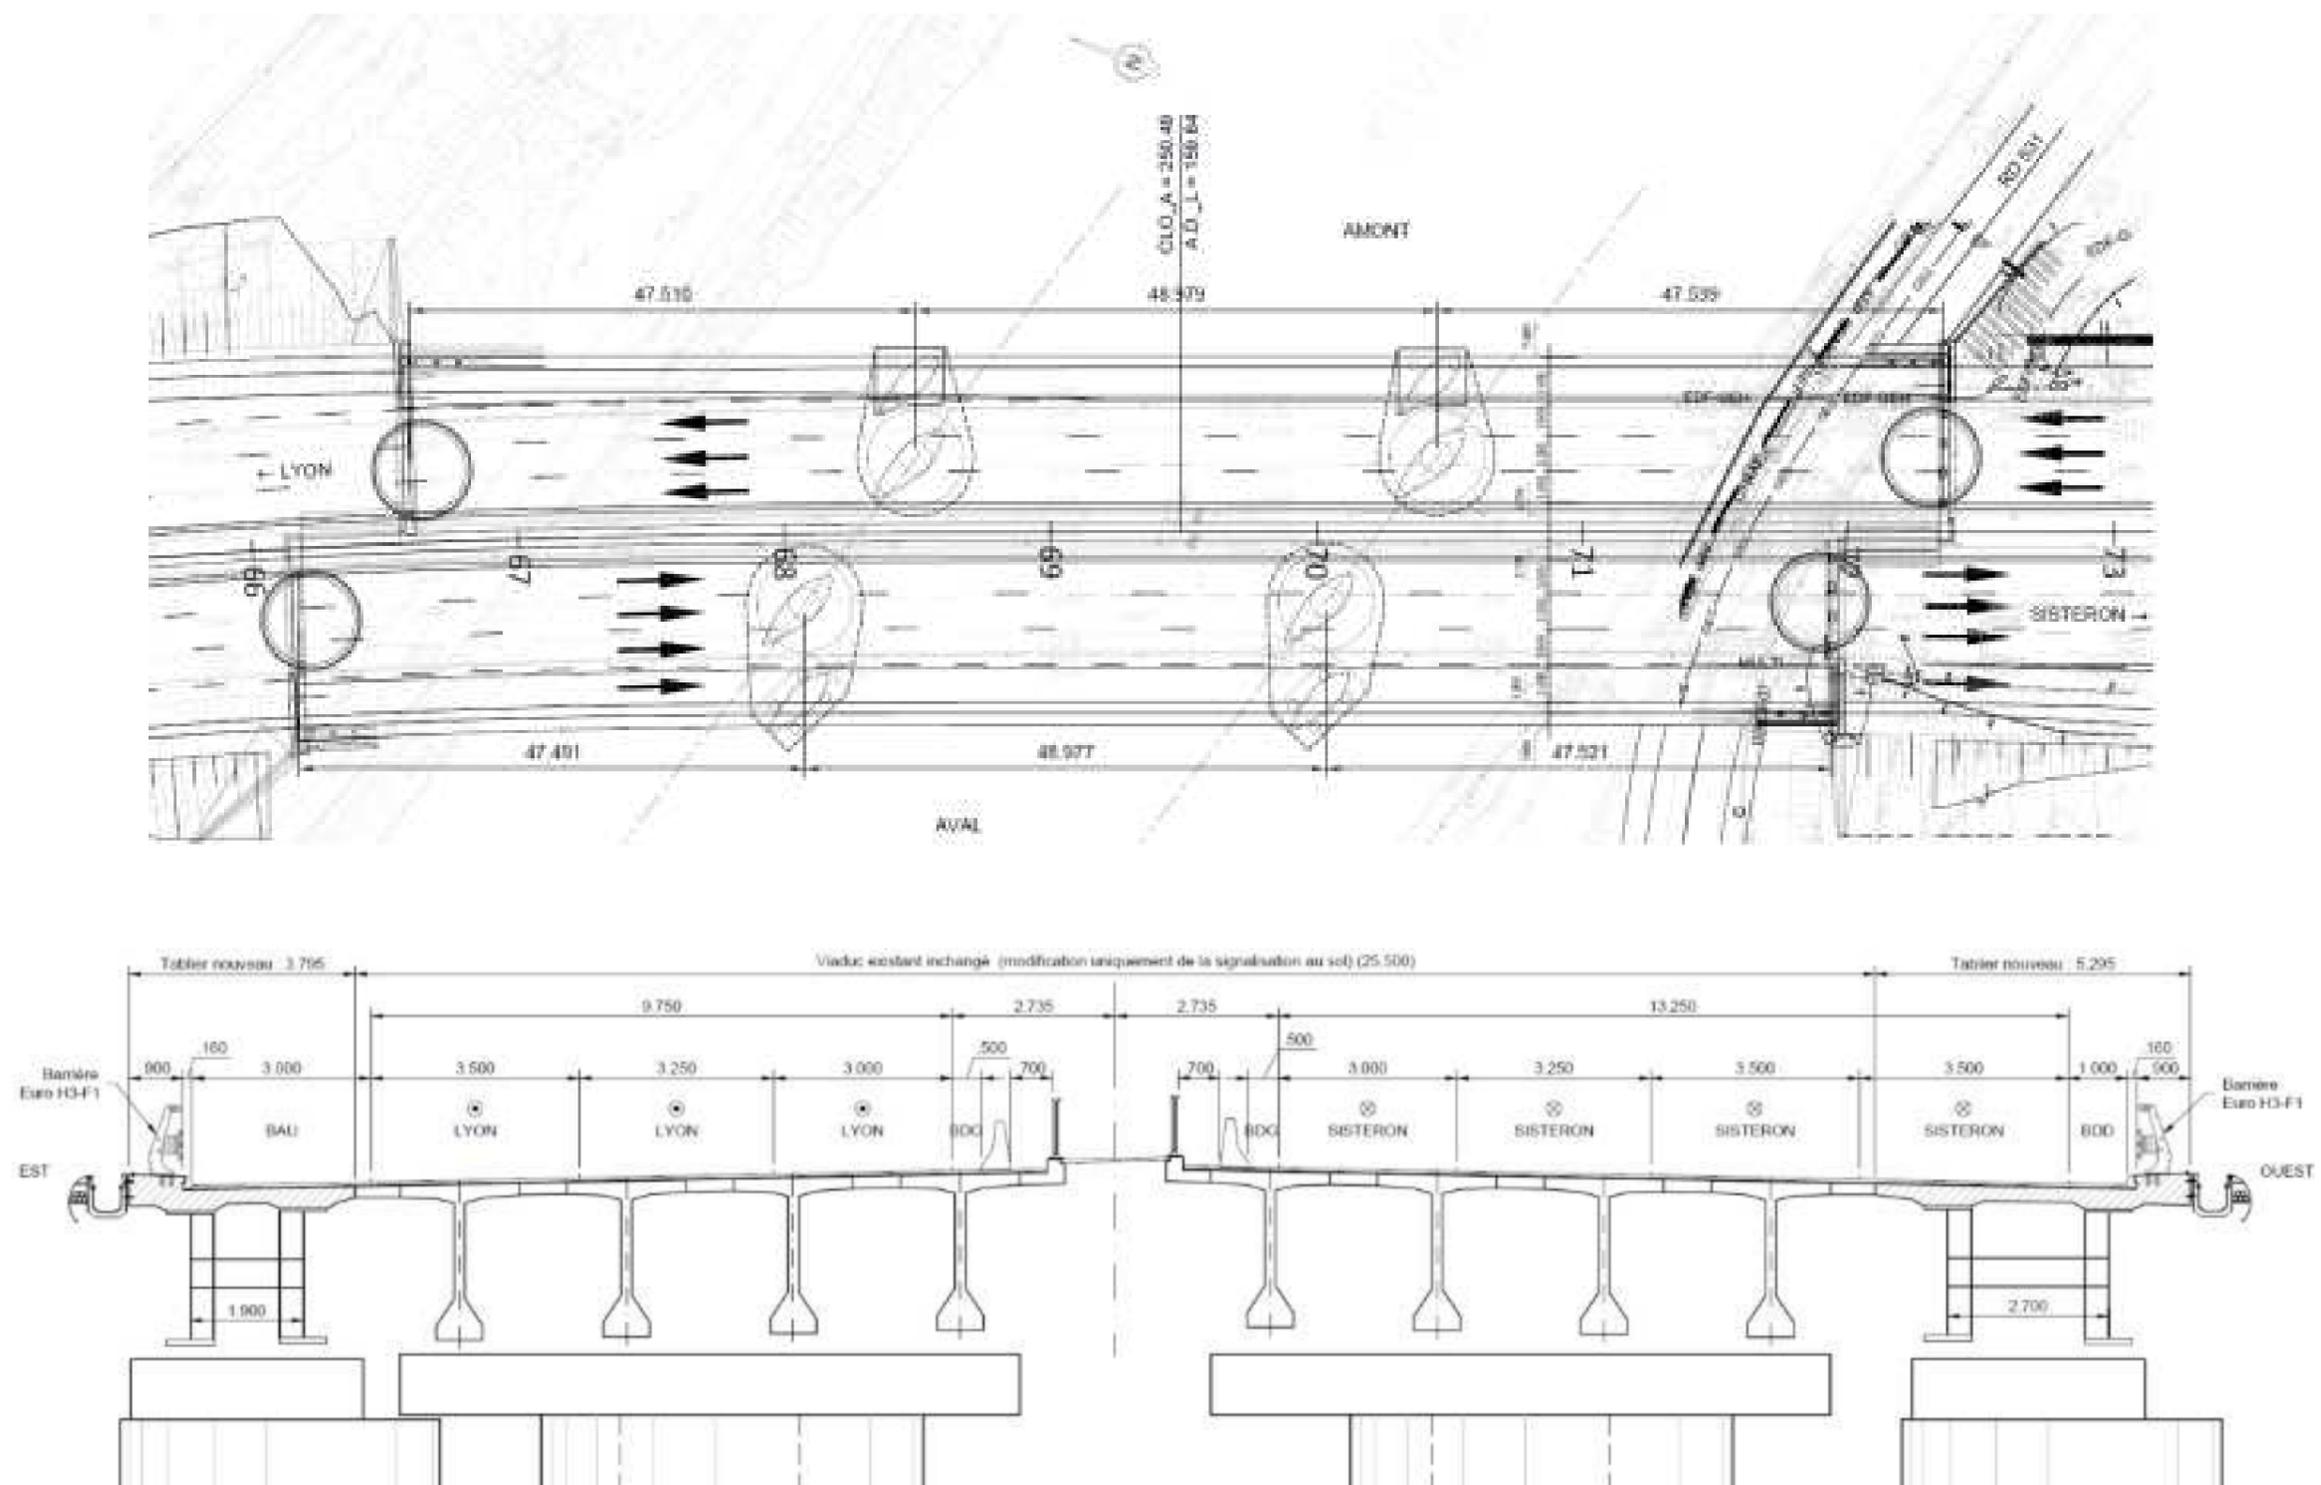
Élargissement du viaduc sur Isère par tabliers neufs connectés à l'ouvrage existant - Vue en plan et coupe des tabliers
